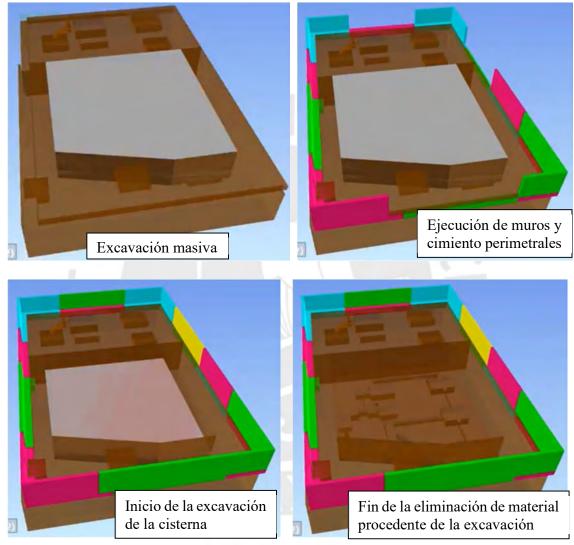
Secuencia de la construcción de los elementos del anillo 3 y de la excavación de las cisternas adaptado al proyecto LIRI.
